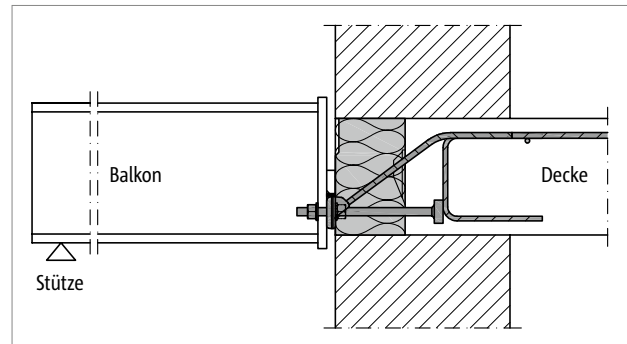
Schöck Isokorb® XT Typ SQP: Anschluss an die Stahlbetondecke; monolithische Konstruktion der Wand
